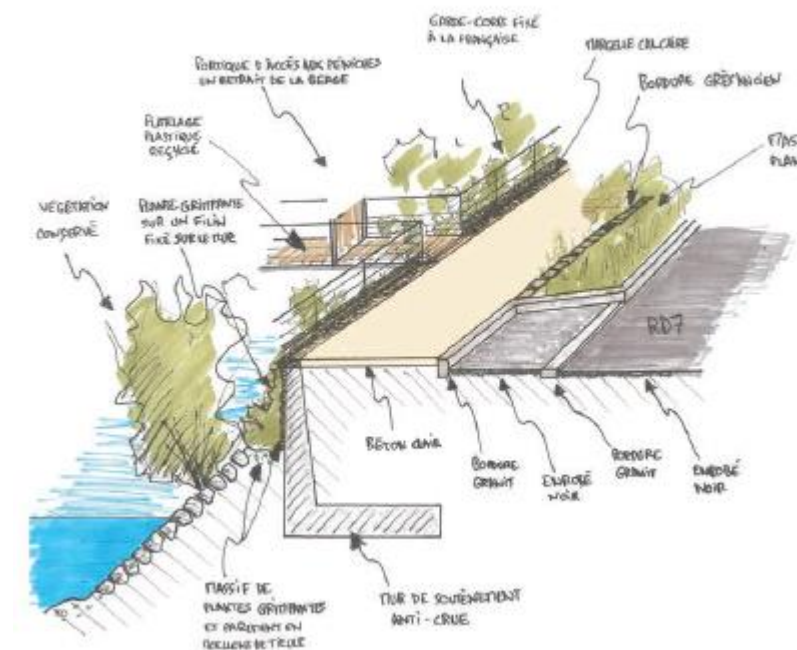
Bloc-diagramme de principe sur les zones avec murs de soutènement en béton
